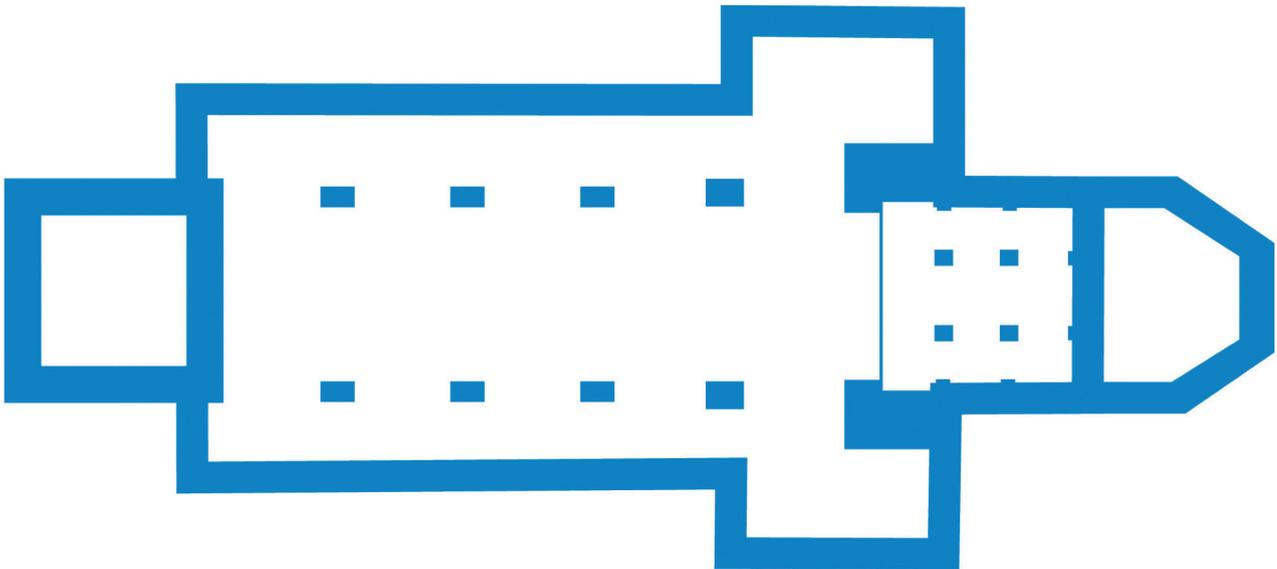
Ohrdruf Schloss Ehrenstein, Grundriss der Peterskirche um 1300
